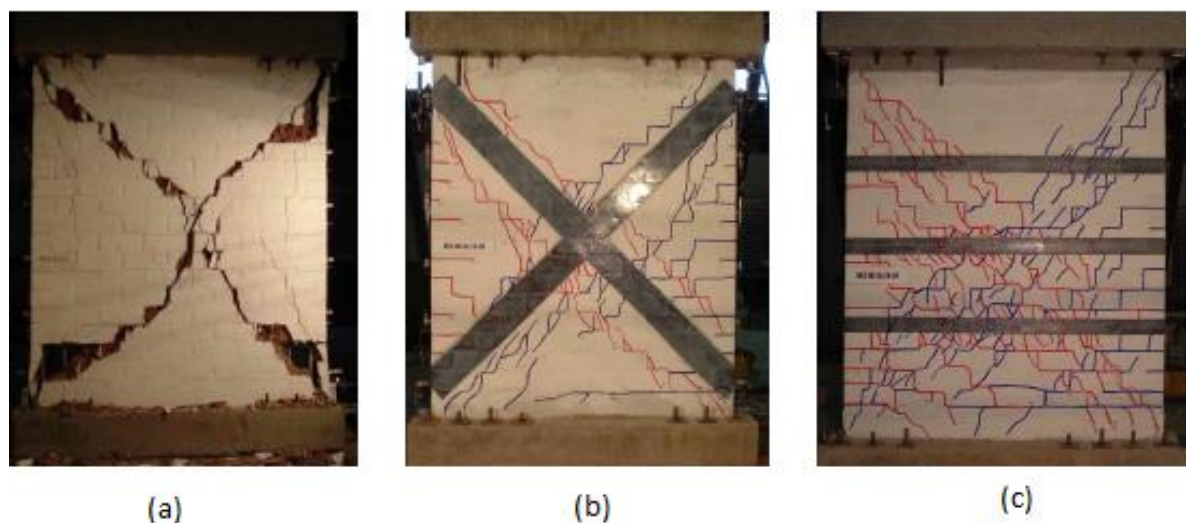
Patrón de grietas presentes en los muros según el tipo de configuración utilizado con FRP. (a) Muro sin reforzamiento, (b) Muro con configuración diagonal, (b) Muro con configuración horizontal
